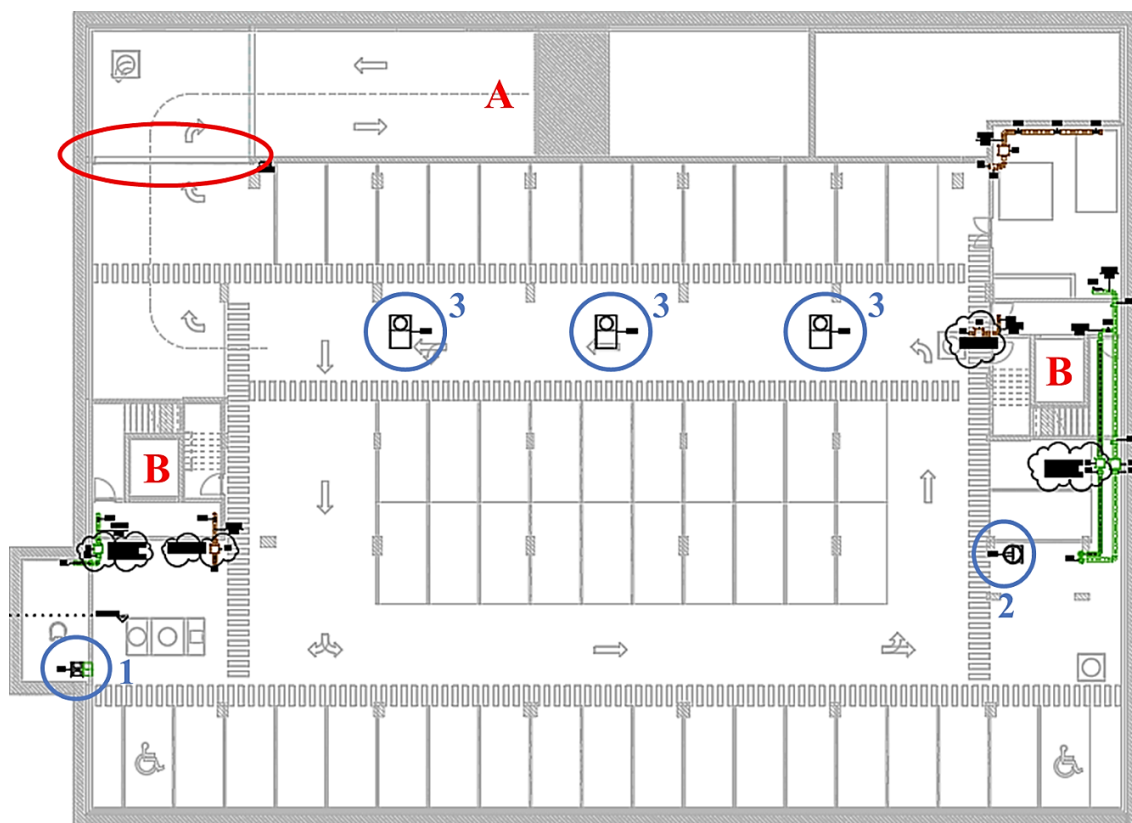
Layout* do piso -3: 1 – ventilador de insuflação, 2 – ventilador de extração, 3 – ventiladores de indução, A – rampa de ligação ao piso -2, B – vias de evacuação vertical.
